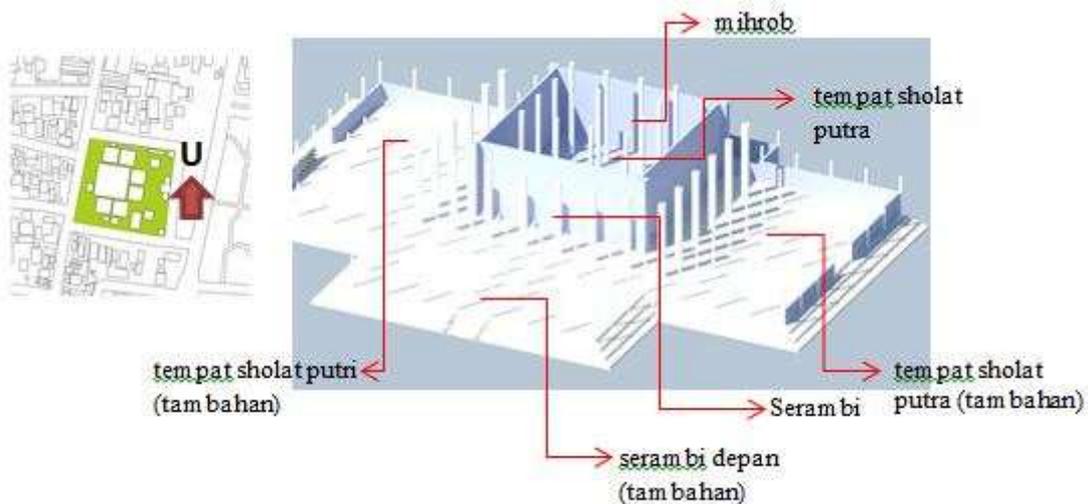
Simetri ruang pada denah masjid Jamik Sumenep
